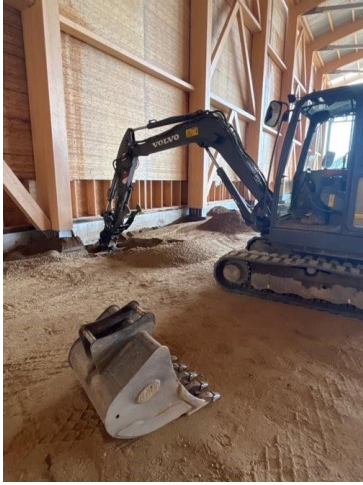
Zanja prefabricada ILDFA para nuevas construcciones
